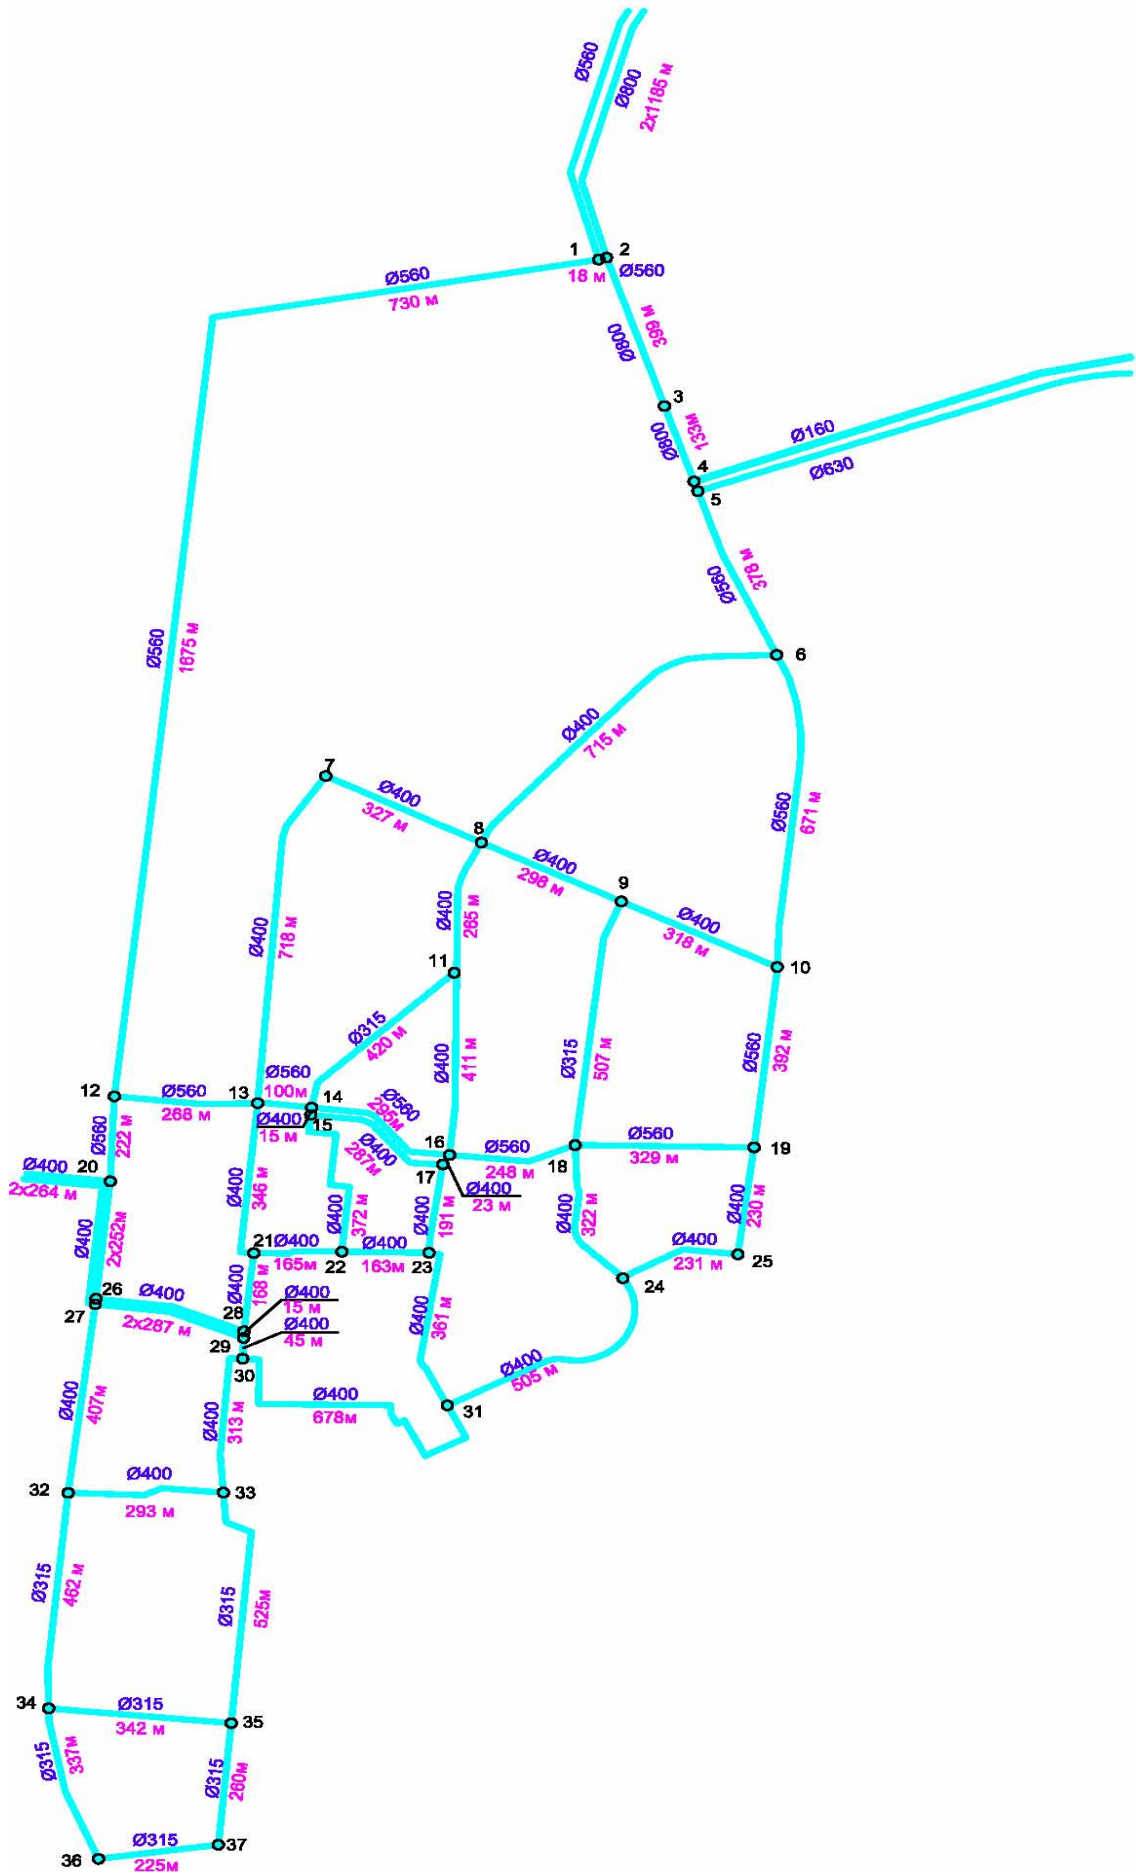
Расчётная схема водопроводной сети зоны "Кудрово" на 2030 г.
